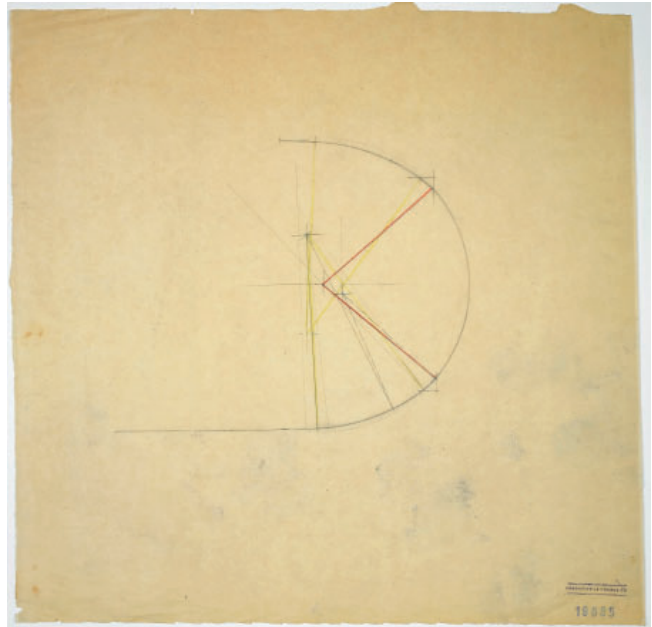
Croquis de la planta de la escalera, Atelier LC-PJ. FLC 19685.
